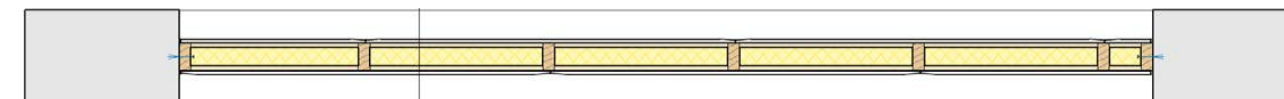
bovenaanzicht van meting nr. 7 met wandconstructie HSB 232/2.89*89.2.AA
